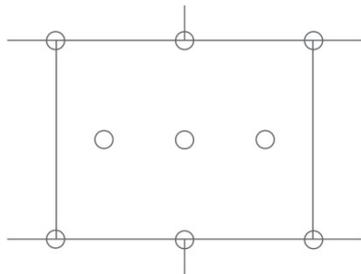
Panneaux PTP-S-035 de dimensions 800 x 625 mm – plans de chevillage en plein (espacement entre chevilles ≥ 200 mm)
